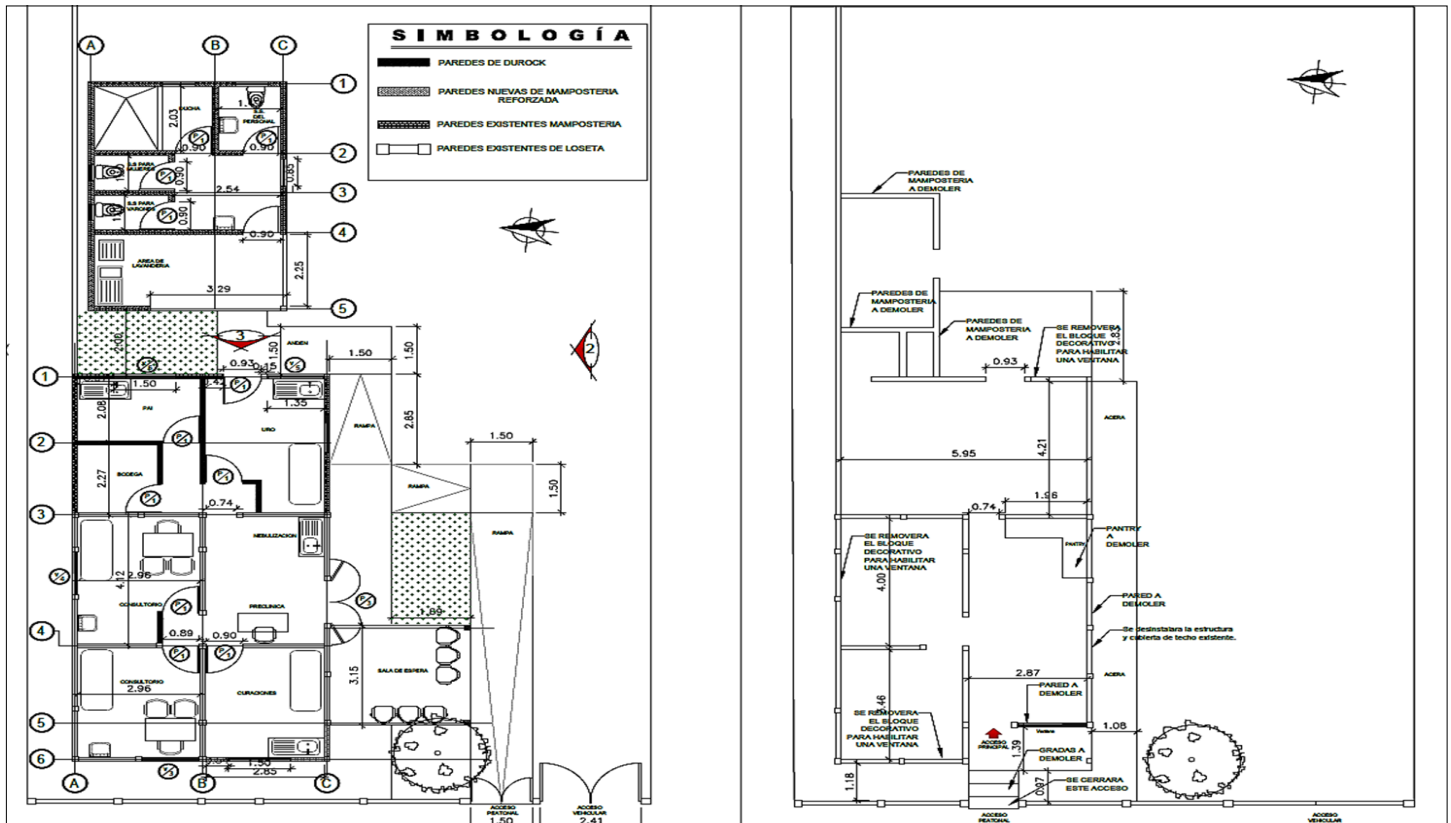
Planta Arquitectónica Puesto de Salud/Fuente: Elaboración propia.
